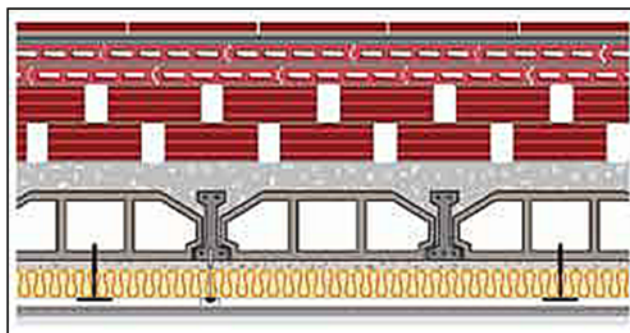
Esquema aislamiento bajo cubierta. Año 2009. Fuente construmatica.com.
